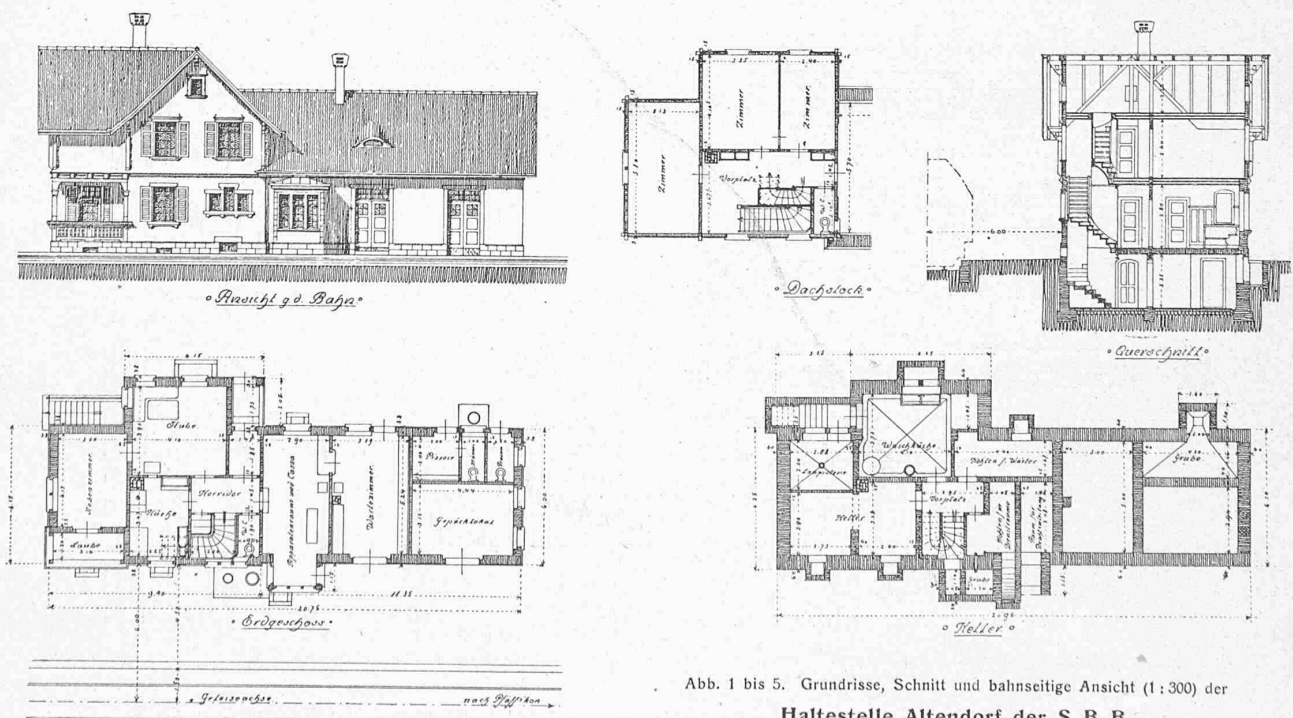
bis 5. Grundrisse, Schnitt und bahnseitige Ansicht (1:300) der
